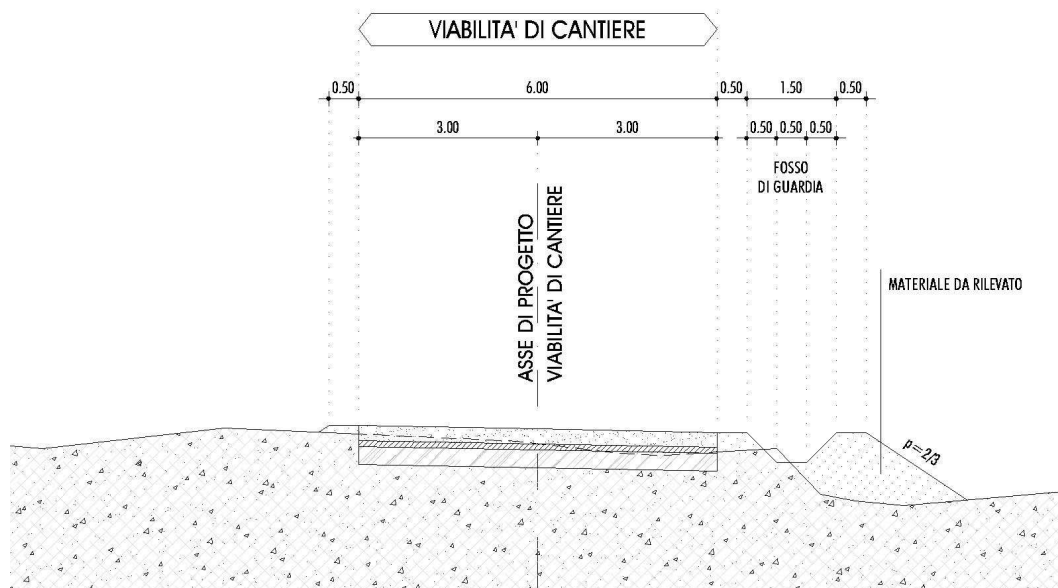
Stralcio sezione tipo viabilità di cantiere
